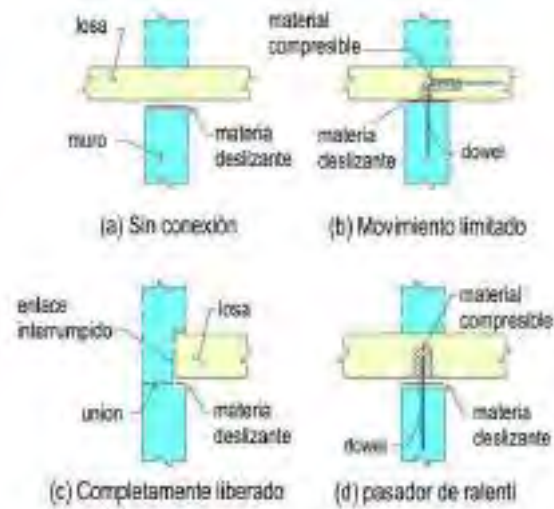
Posibles configuraciones entre muro y losa (Fuente ADAPT 2016)
